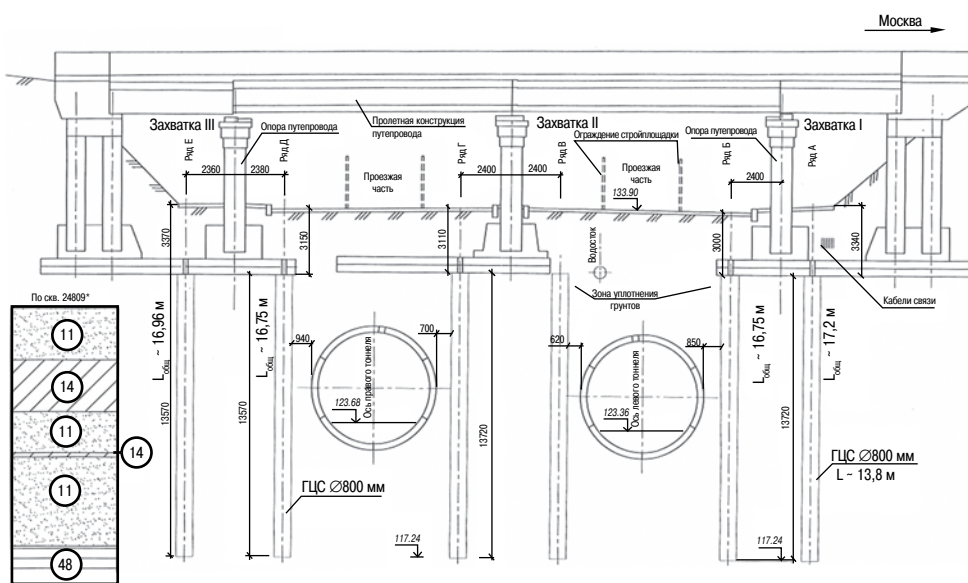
Схема устройства грунтоцементных свай в основании фундаментов опор путепровода
